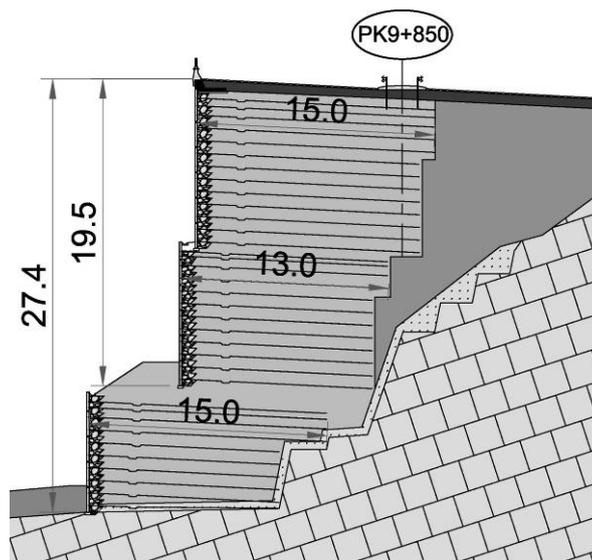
Coupe transversale schématique pour la section du mur la plus haute
